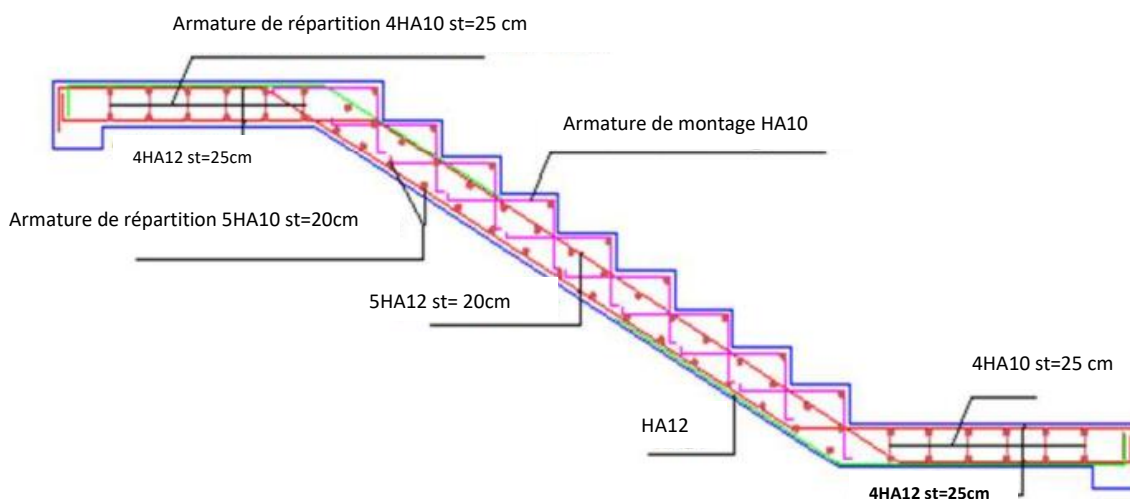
Ferrailage des escaliers des étages courants.
